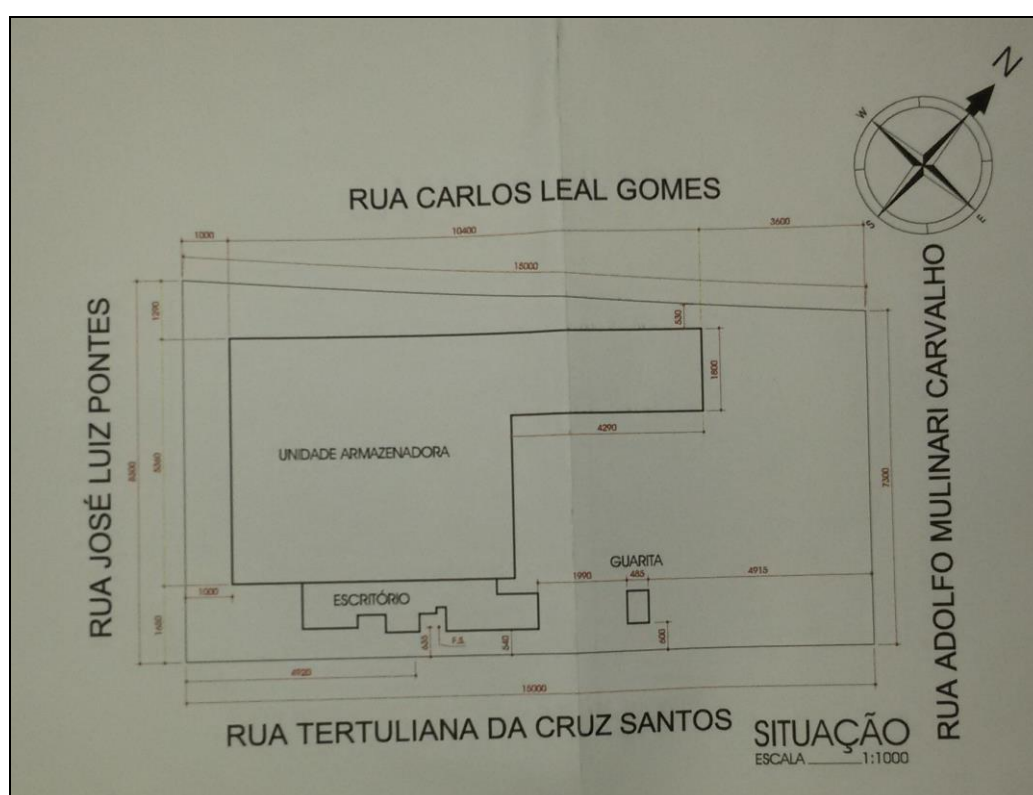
Croqui esquemático da empresa e suas vias de acesso
